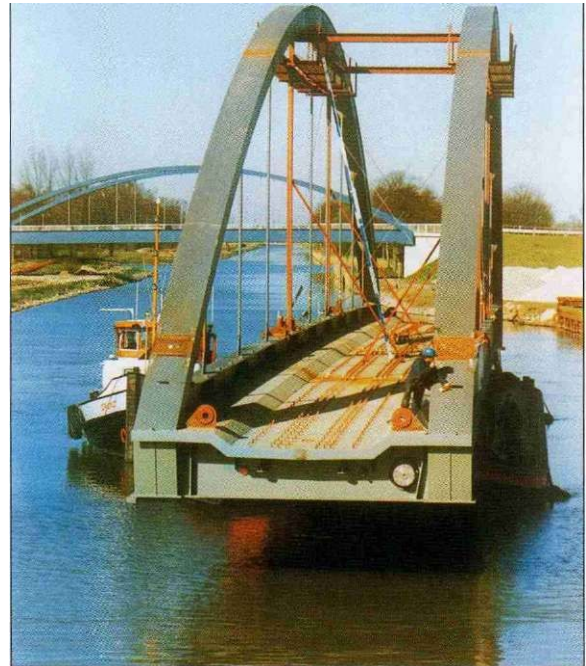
Przesunięcie poprzeczne mostu nr 441;
